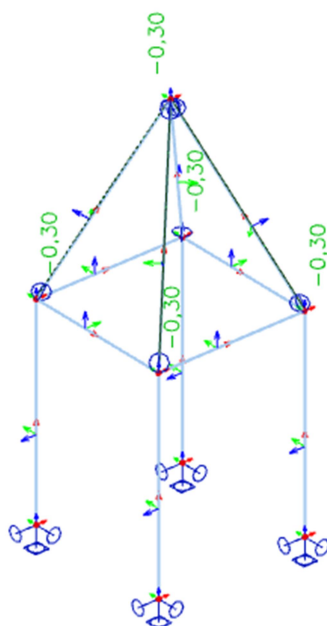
Konstrukce 1b, Zatěžovací stav ZS3
